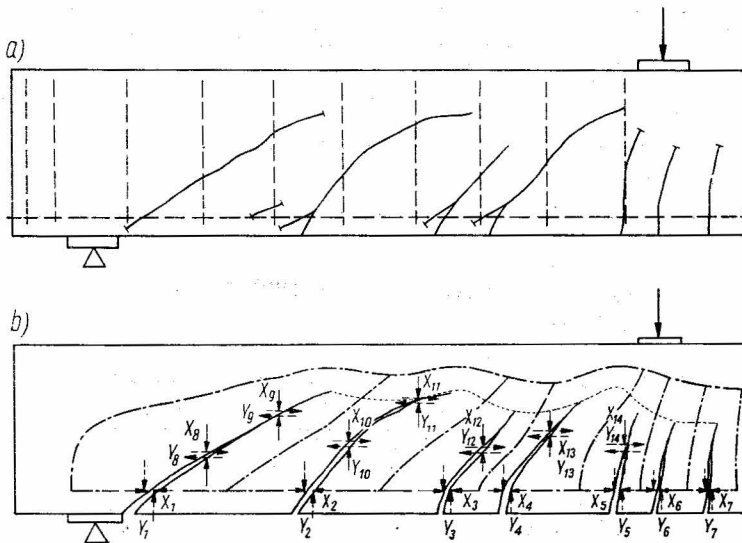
Schéma fondamental et efforts surabondants dans les barres d'une poutre fissurée en béton armé : a) disposition des fissures, b) schéma fictif d'un treillis avec des liaisons surabondantes [73]
